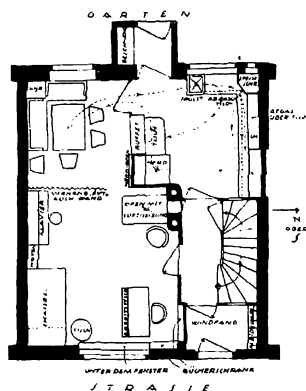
Verbeßertes Reihnhaus Erdgeschoß
